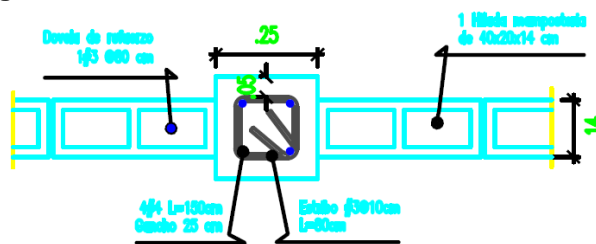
Planta cimentación cerramiento cancha múltiple.
